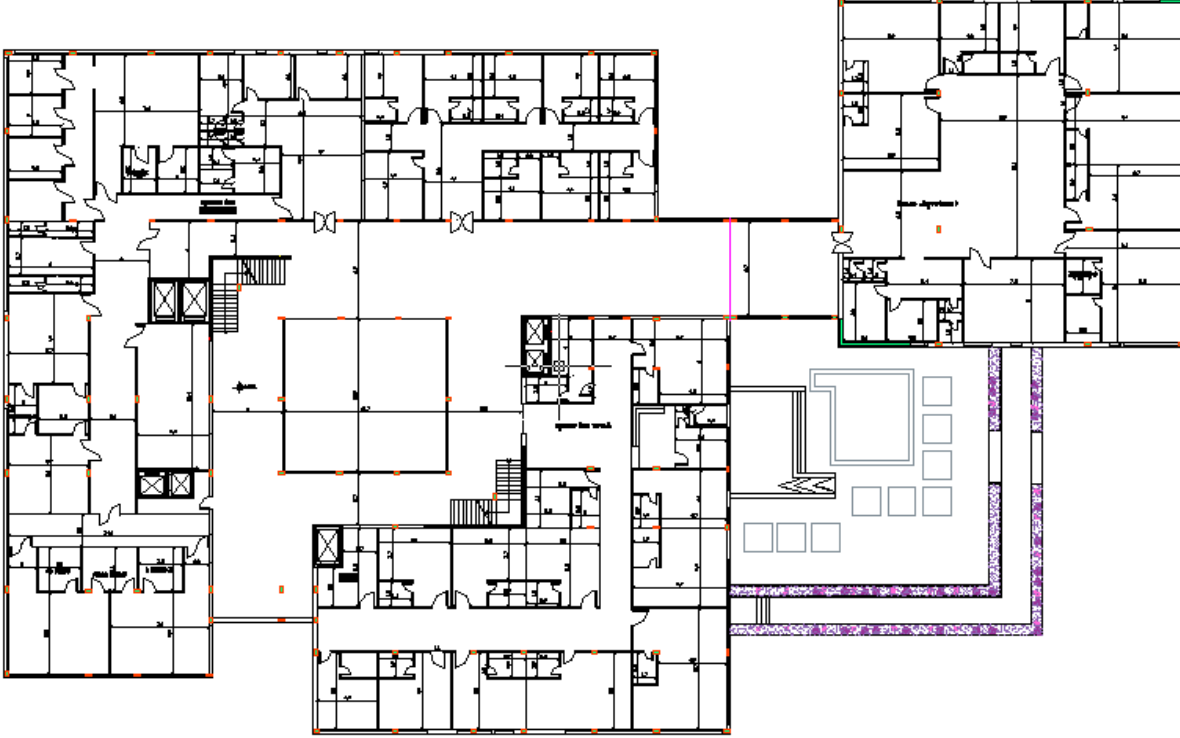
المسقط الأفقي للطابق الأرضي.
